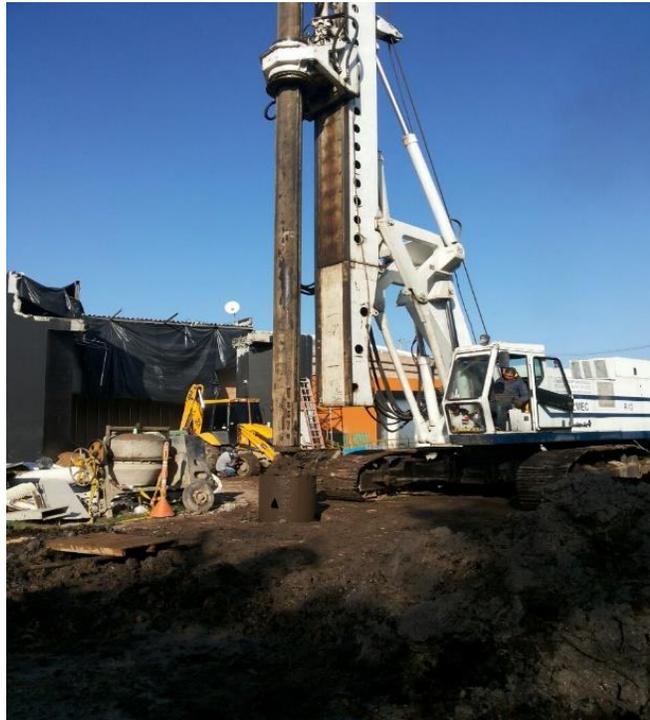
Excavación de pilote con piloteadora. Fuente: Fotografía propia
